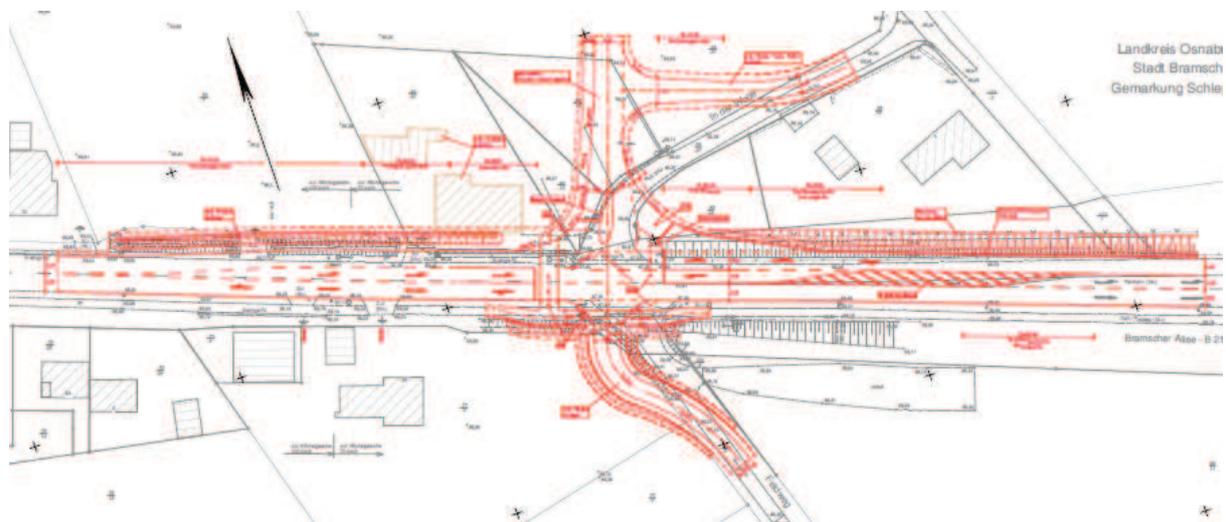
Lageplan Anschluss Plangebiet B218 (Büro Westerhaus)
